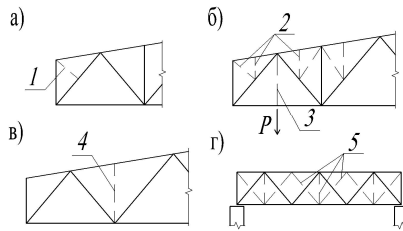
Схема усиления ферм введением дополнительных элементов:
